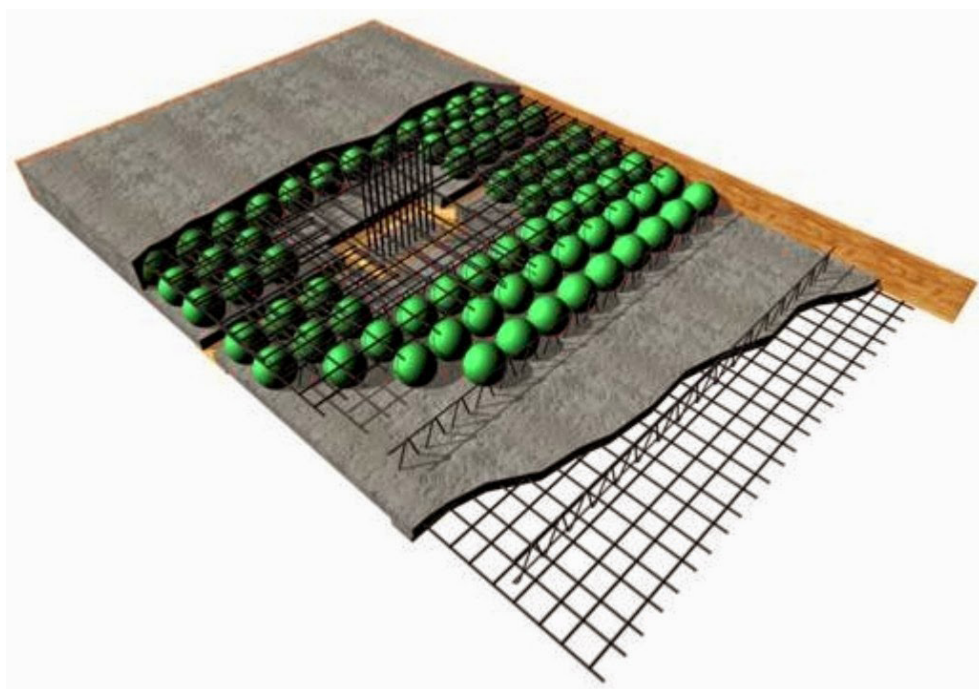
Losa Bubbledeck. (Bubbledeck UK , 2008)
